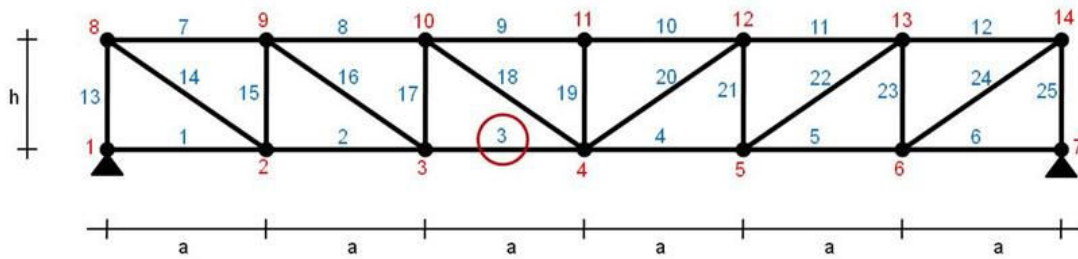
Elemento do banzo inferior com aplicação do dano.
